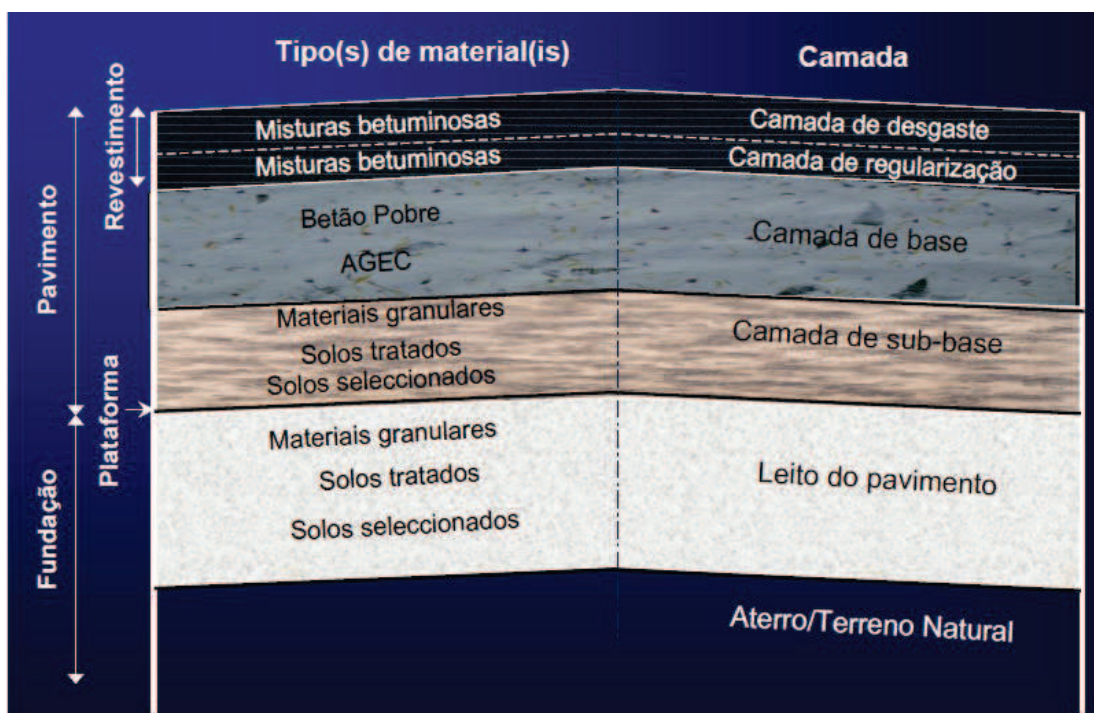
Constituição de um pavimento semirrígido (LNEC, 2005)
